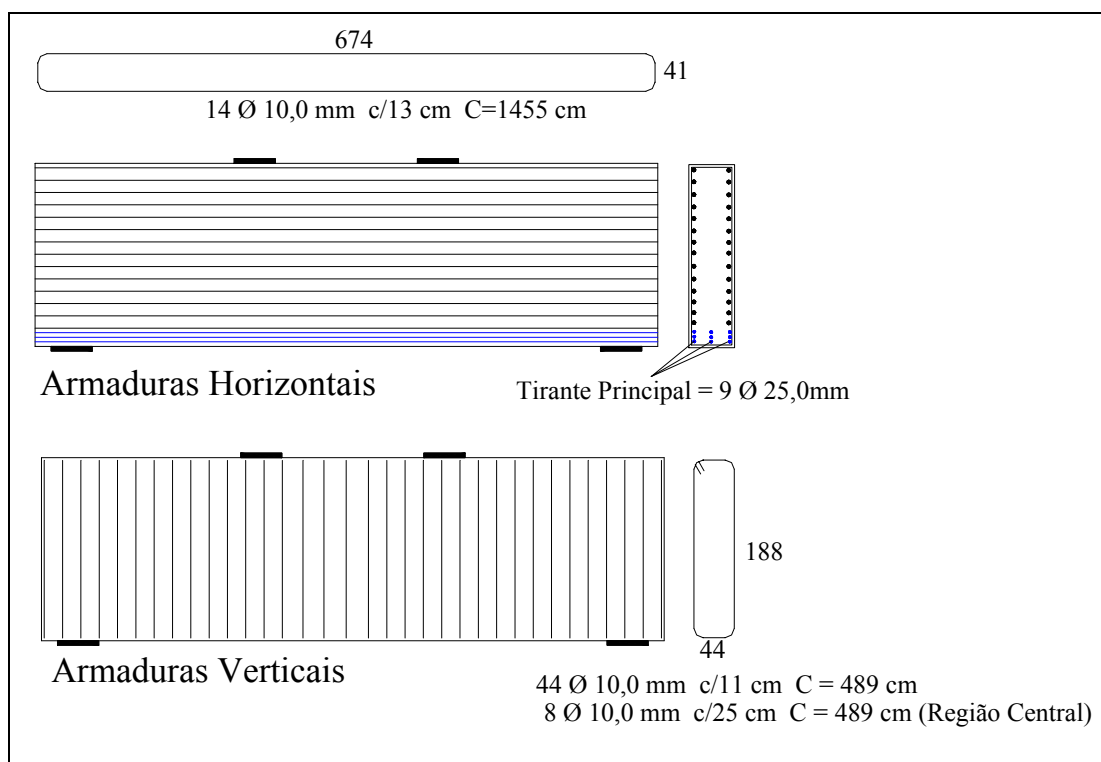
Detalhe de armação da viga-parede analisada utilizando as recomendações da NBR 6118 (2003)
